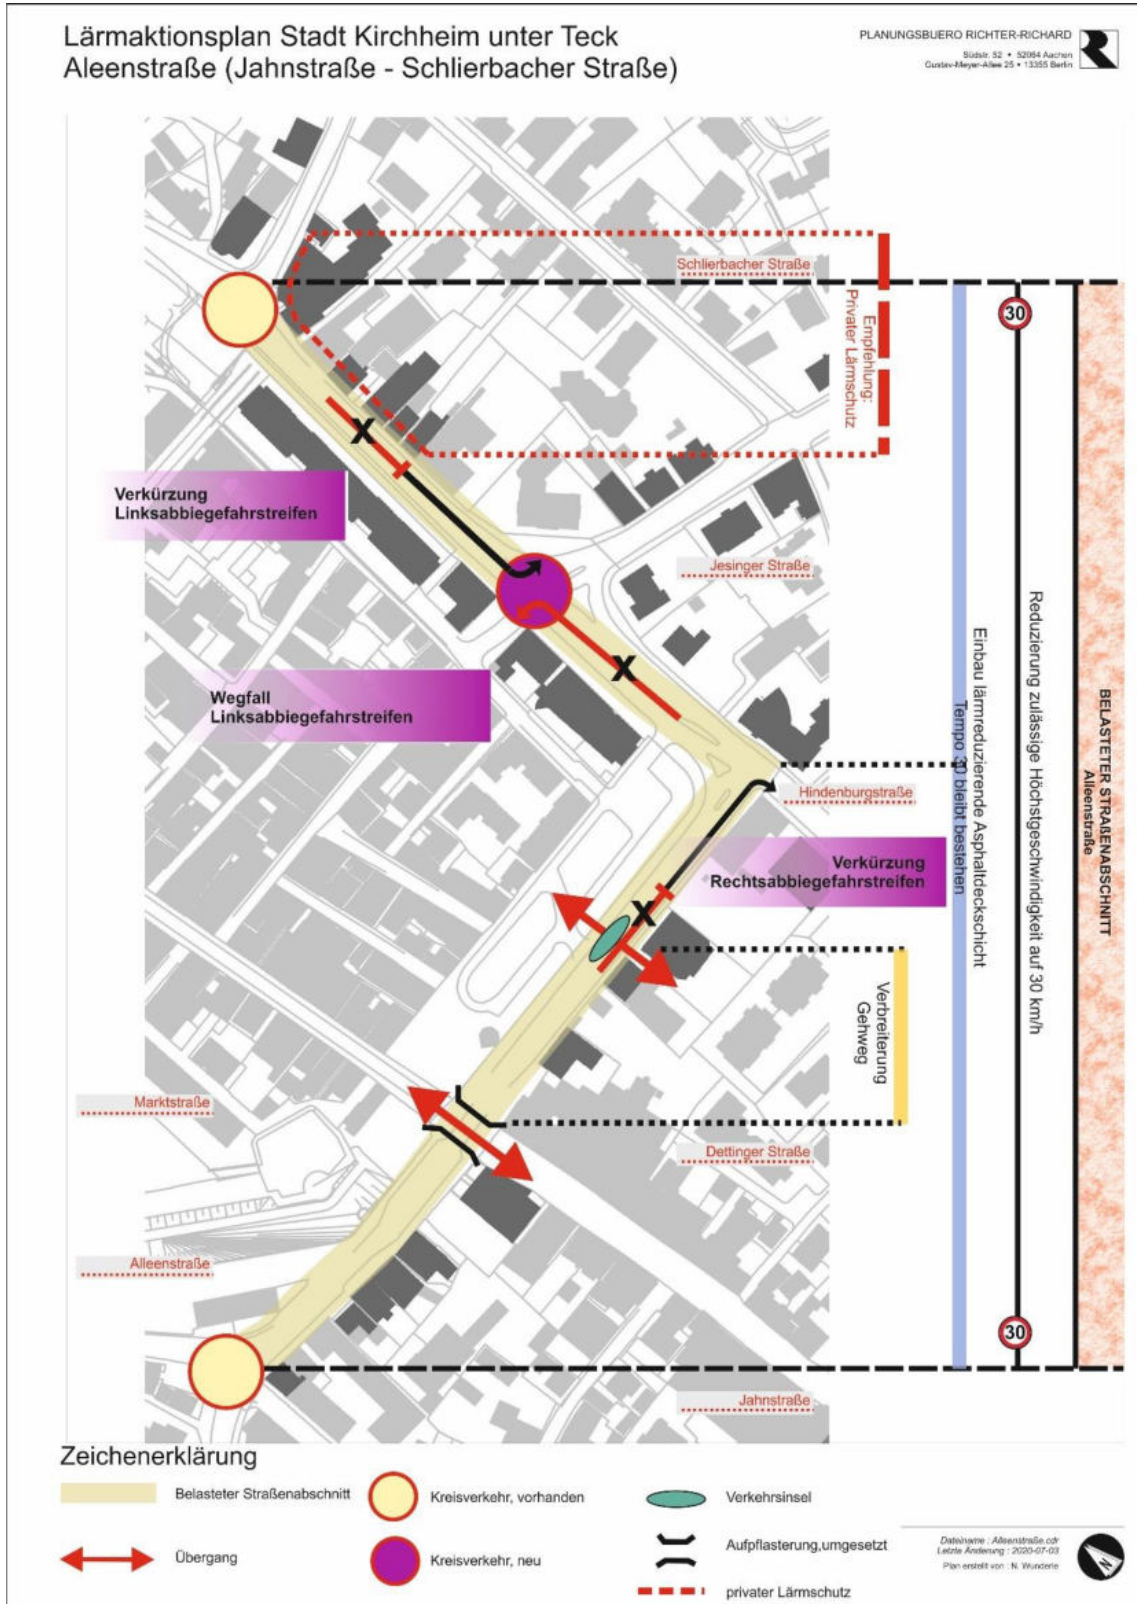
Alleenstraße (Jahnstraße – Schlierbacher Straße)
